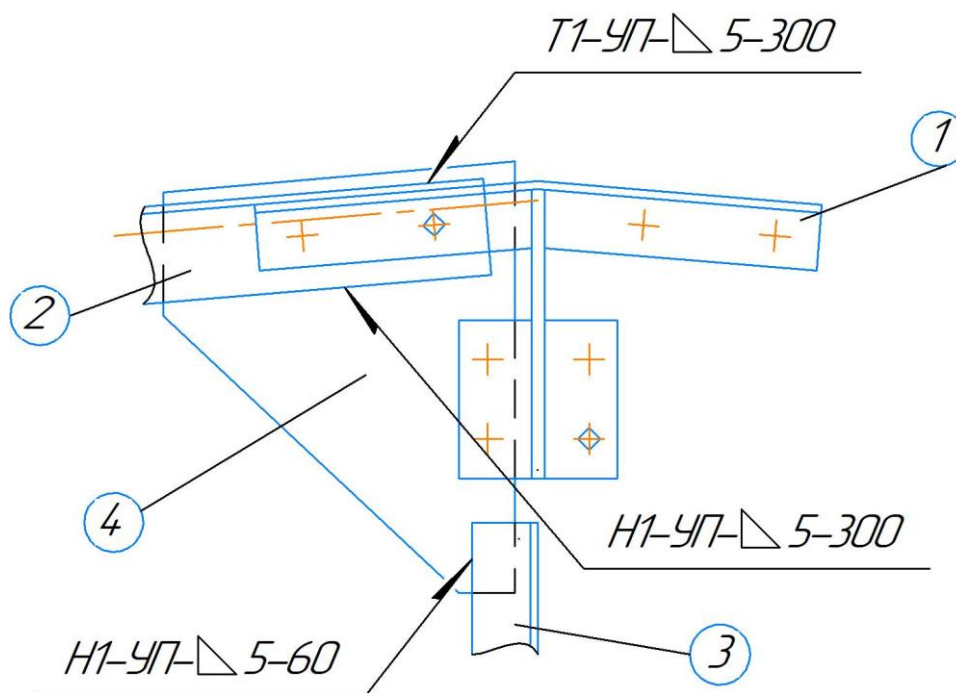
Коньковый узел фермы: 1 – накладка, 2 – пара уголков верхнего пояса фермы, 3 – уголок стойки, 4 – фасонка
